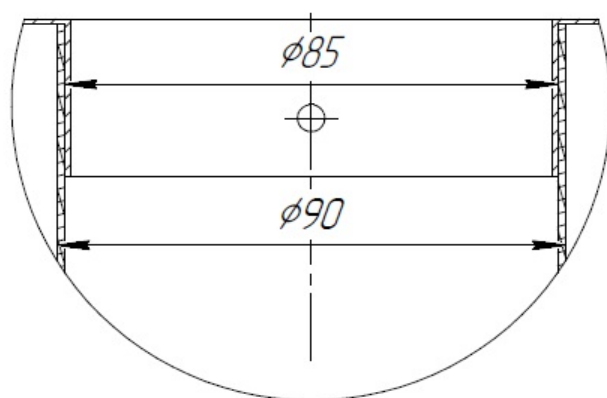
Узел стыковки металлического фланца и пластикового воздуховода со стороны фасада, вид сбоку, поперечный разрез.
